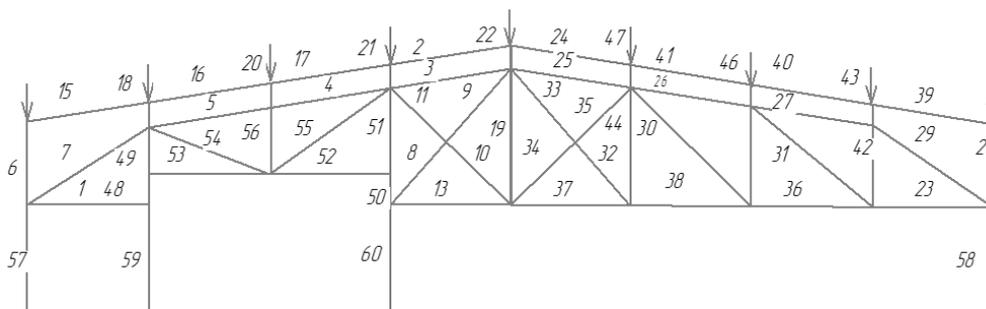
Расчетная схема после реконструкции (указаны номера стержней).
